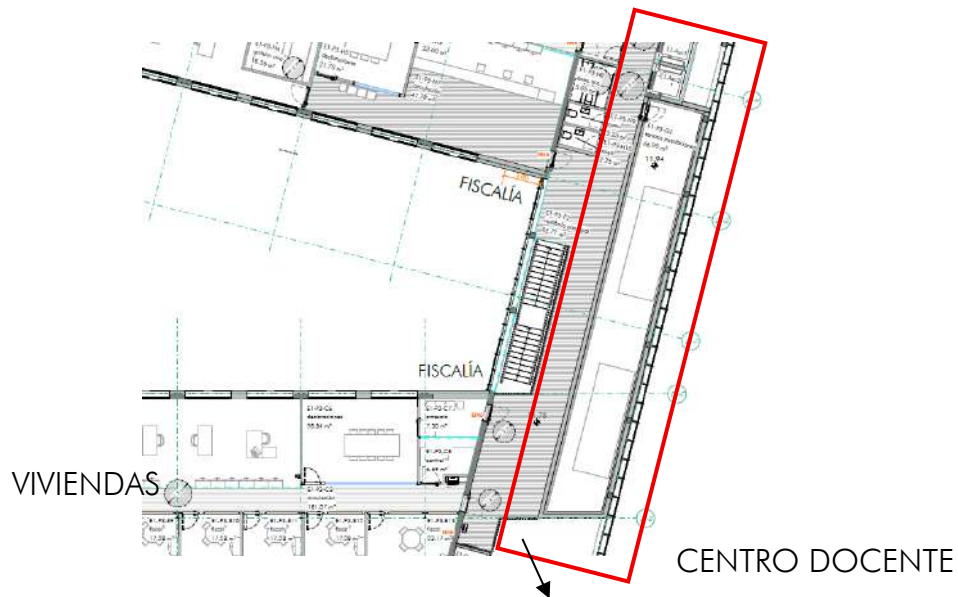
Instalaciones. Planta Tercera. Edificio 1
